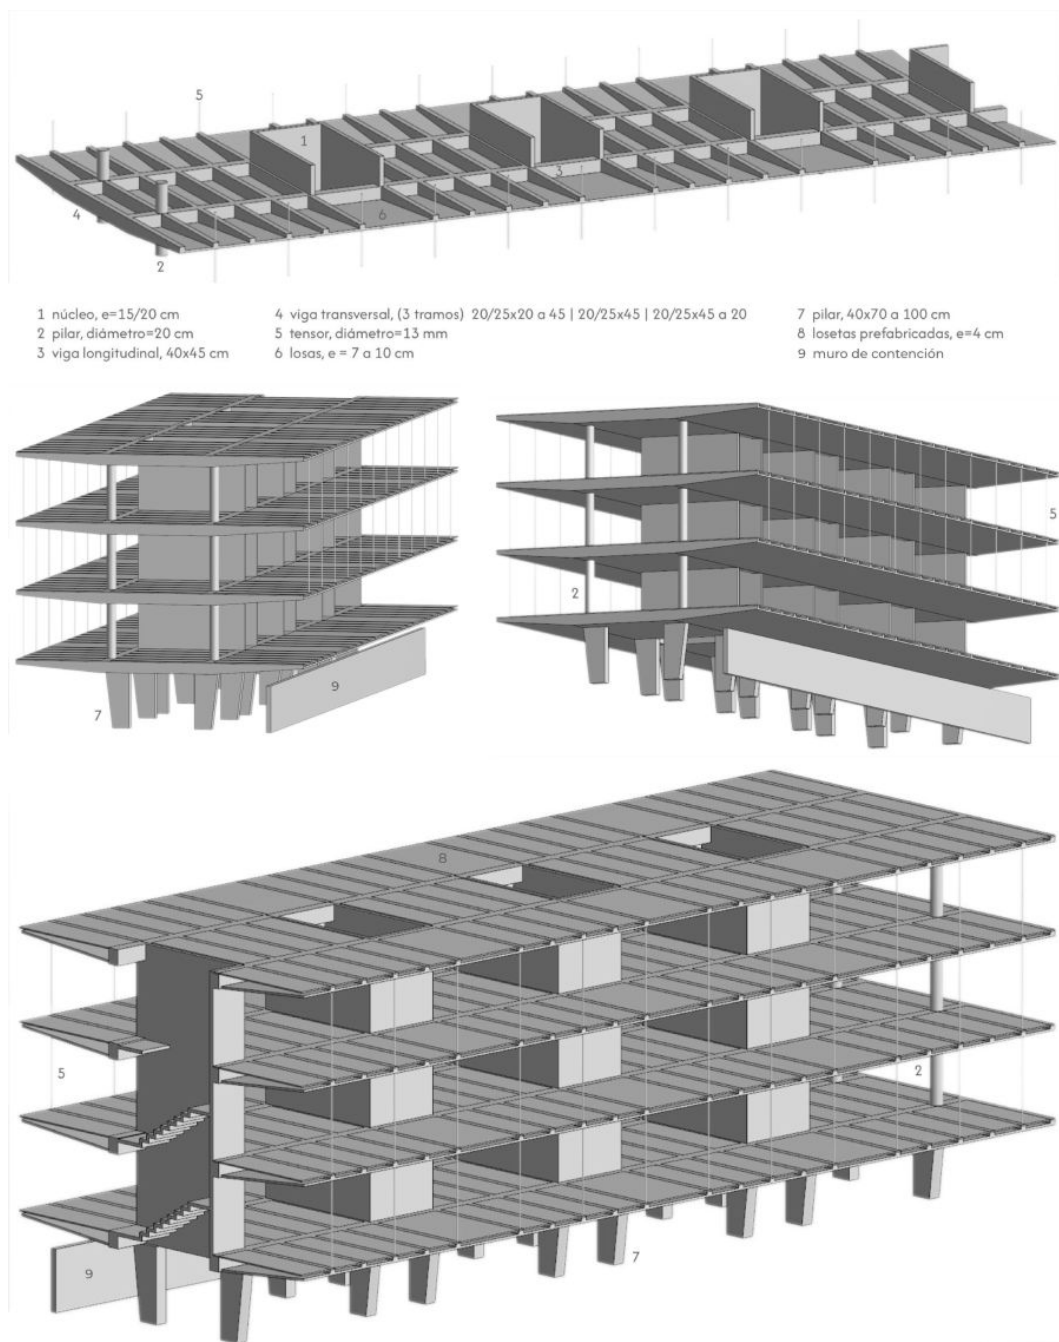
Axonometrías estructurales de un sector de L'Hirondelle entre dos juntas de dilatación: planta tipo y vistas del conjunto.
